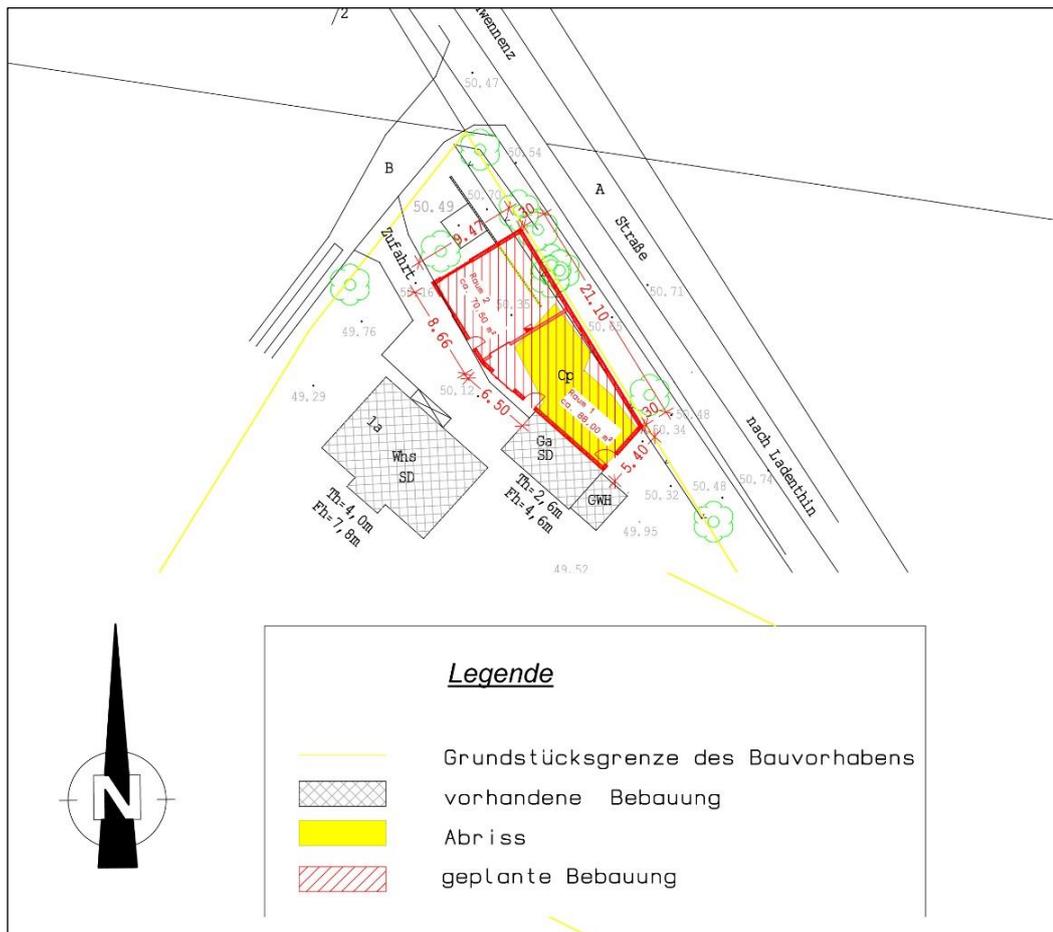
Auszug aus dem Lageplan der Bauantragsunterlagen zur geplanten Tischlereiwerkstatt in Schwennenz (NBS-Bauersiedlung Stand 10/2019)
